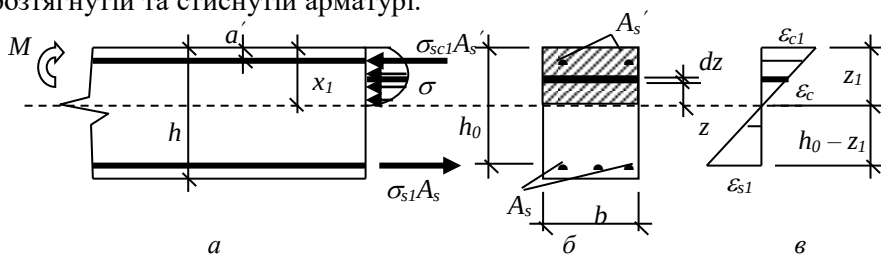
Схема розподілення зусиль (а, б) і деформацій (в) бетону і арматури в розрахунковому нормальному перерізі згинального елемента
